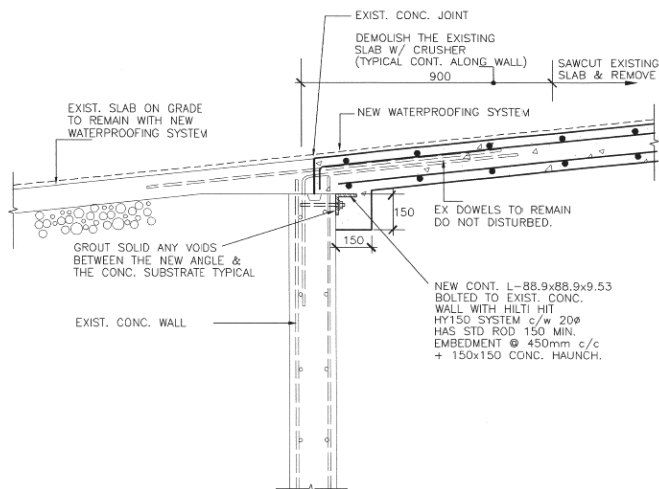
Îmbinarea noului planșeu din beton armat cu pardoseala existentă
